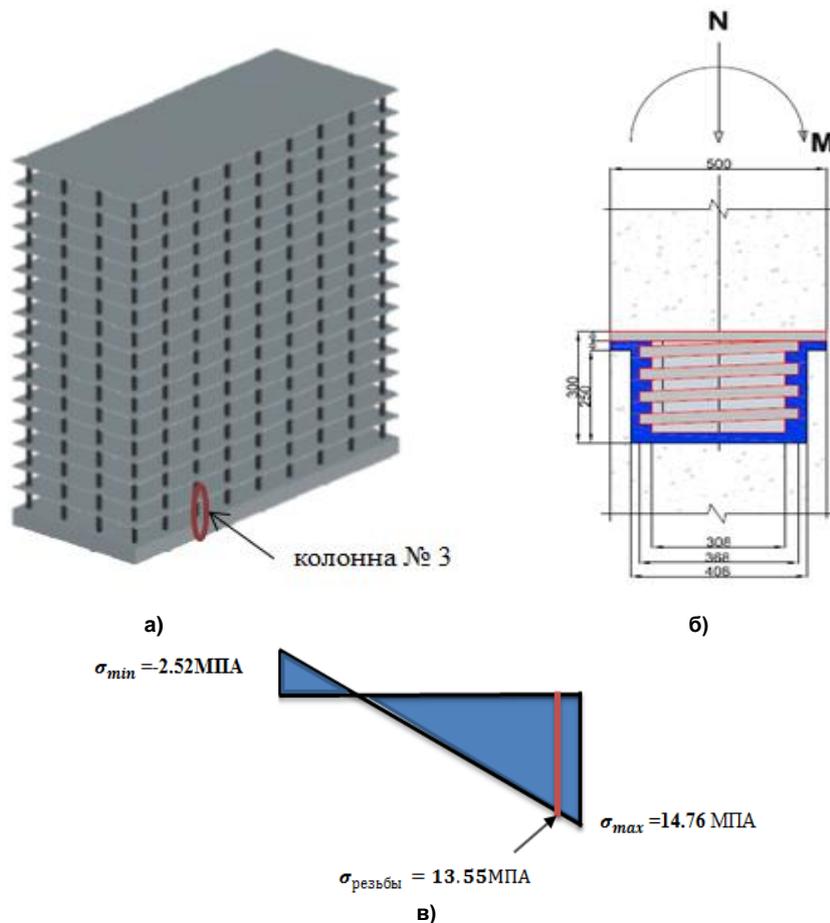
а – многоэтажное здание; б – разрез колонны № 3;
